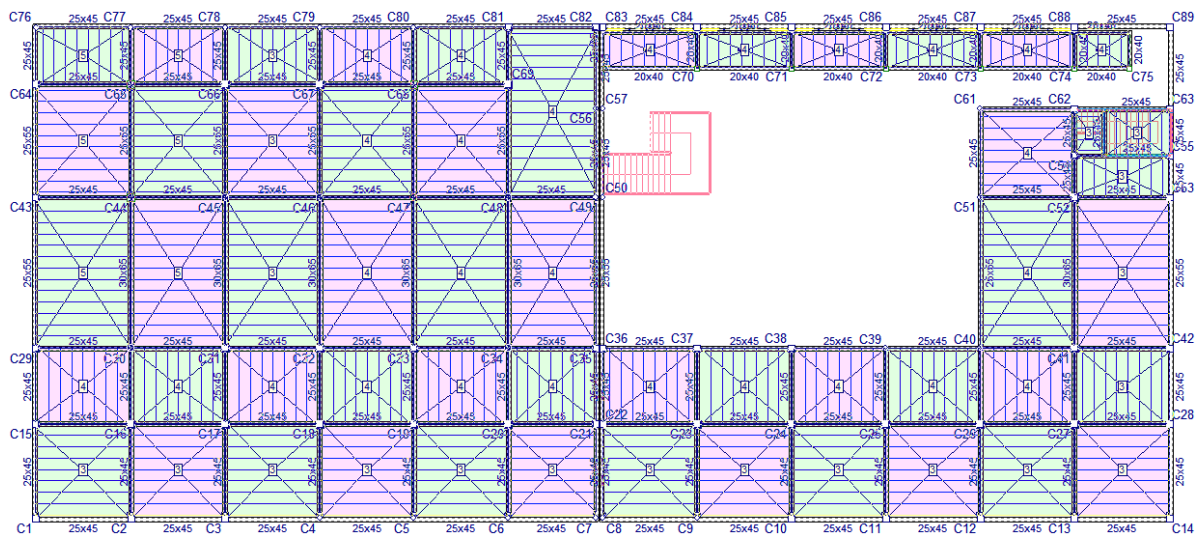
Alternancia de cargas de servicio primera losa (fuente: CYPECAD 2017)
